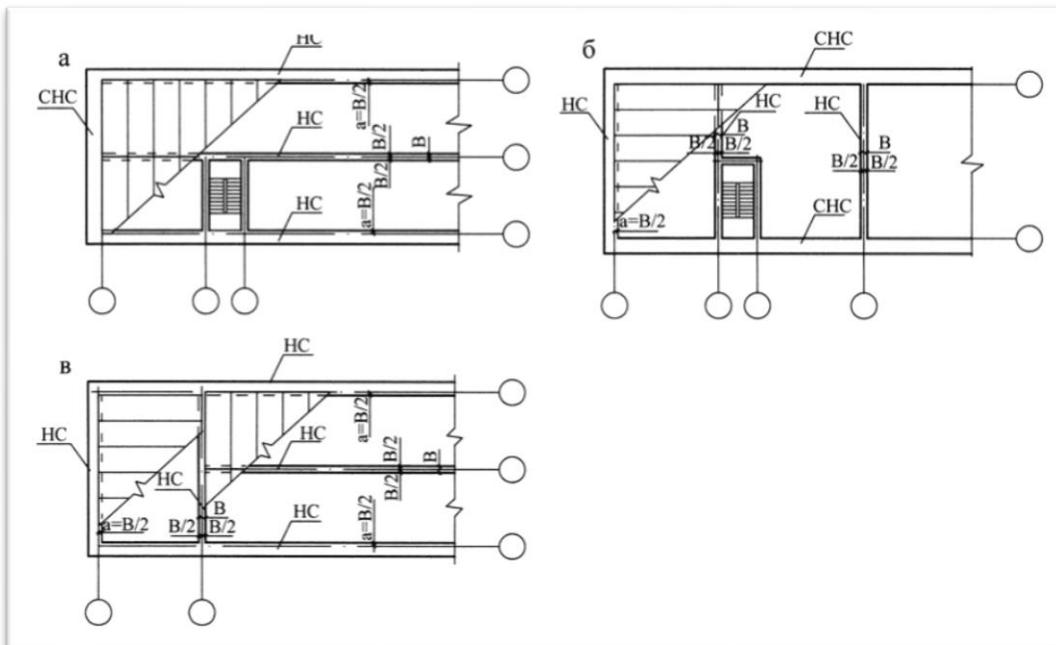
Конструктивные схемы зданий: а – с продольными несущими стенами;
